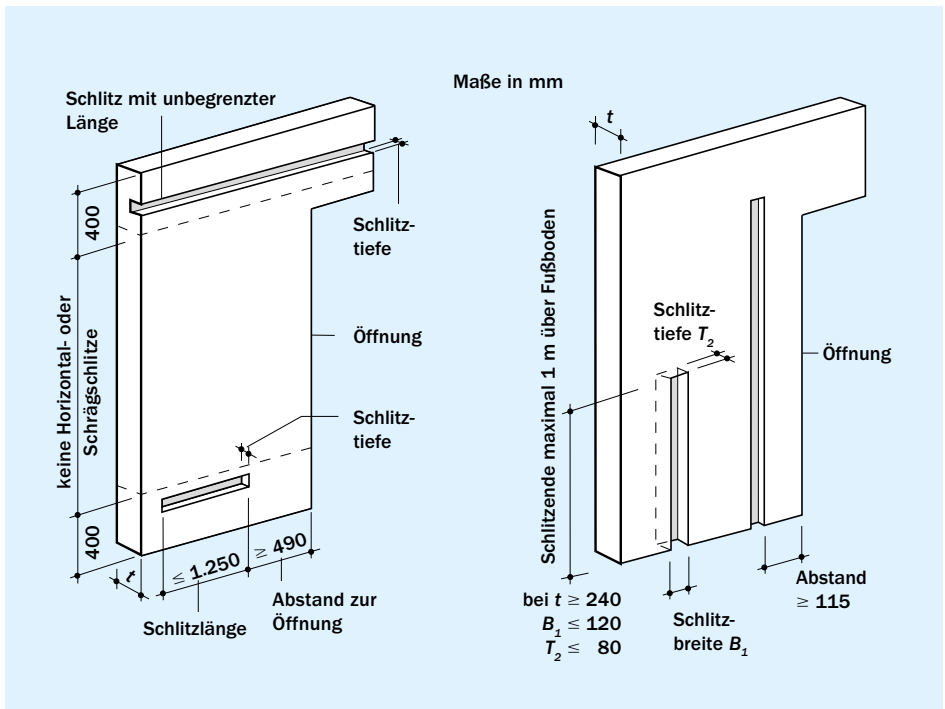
Nachträglich hergestellte horizontale und schräge Schlitz (links); nachträglich hergestellte vertikale Schlitz und Aussparungen (rechts)
